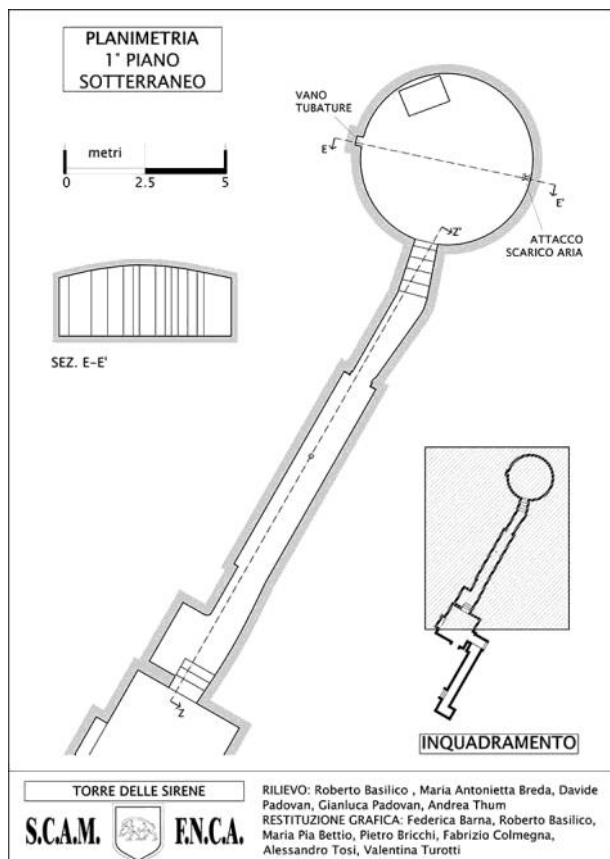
Planimetria del primo piano sotterraneo con il corridoio d'accesso (rilievo dell'Ass.ne S.C.A.M. - F.N.C.A.).
